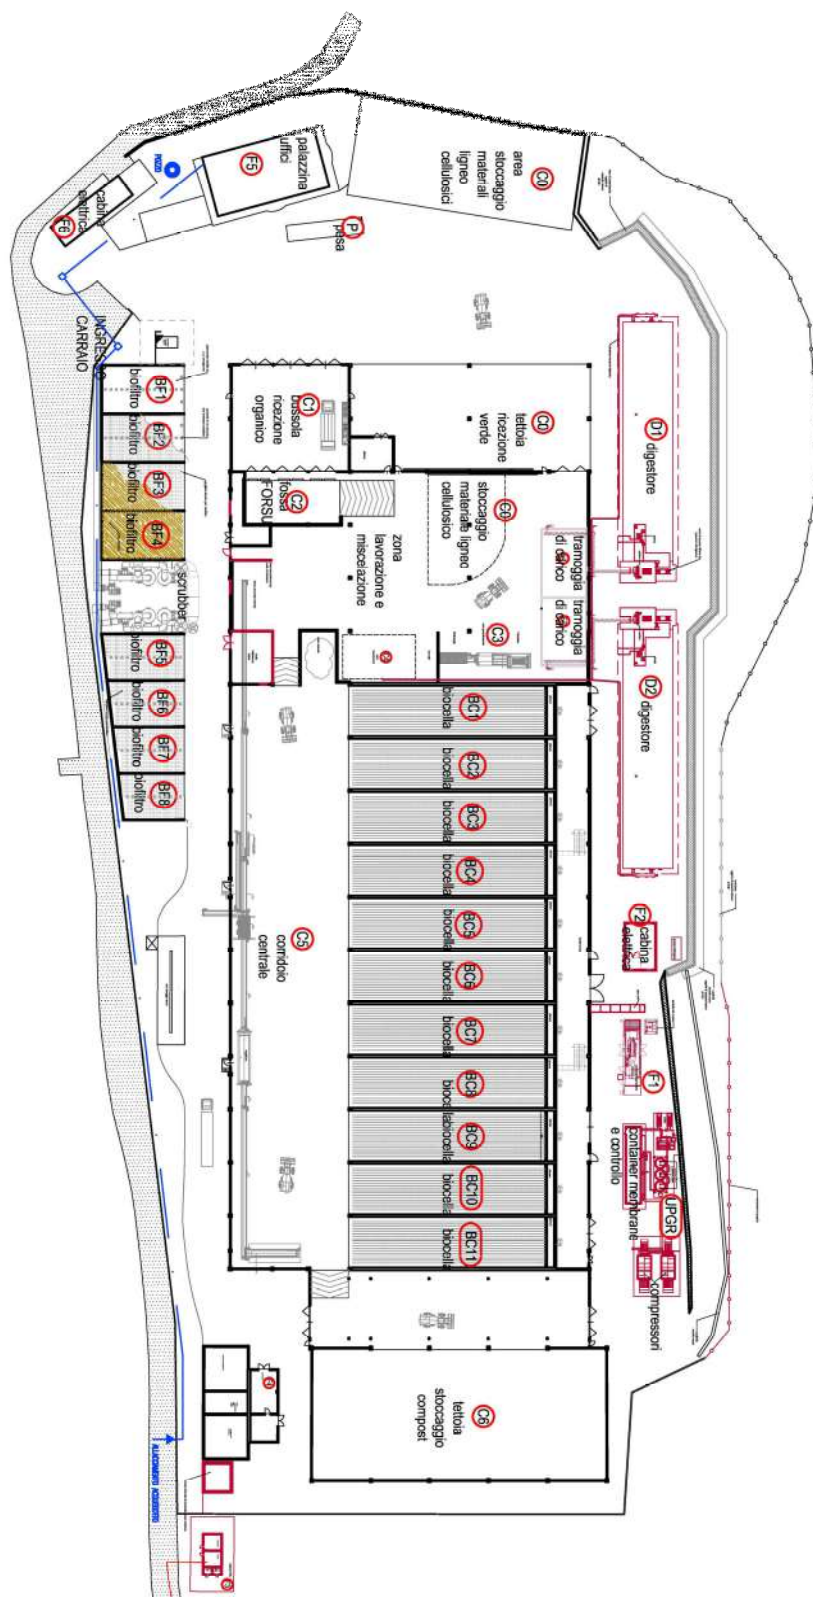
Planimetria dell'impianto nella sua configurazione finale (con digestione anaerobica)
